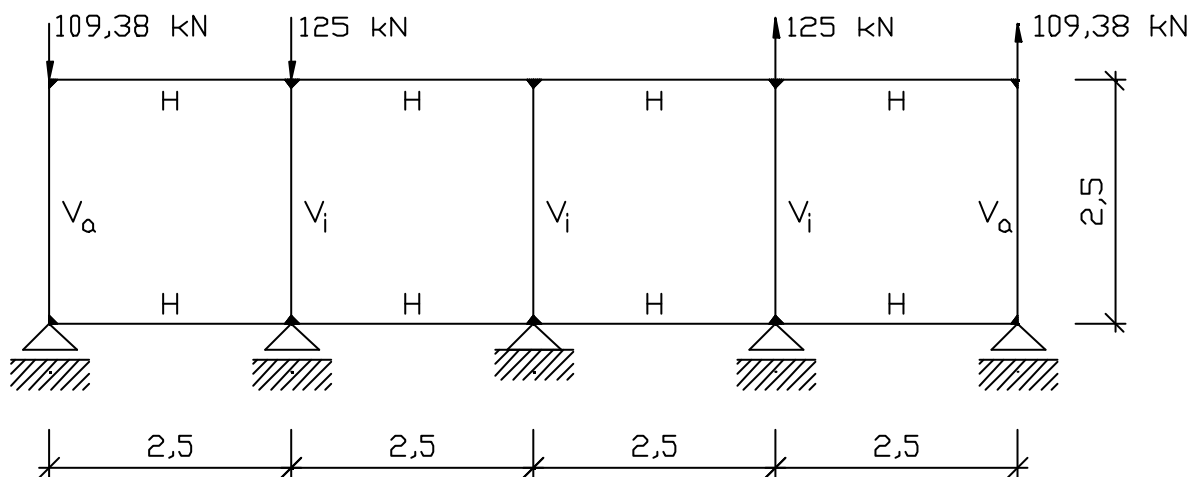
Ersatzmodell für Brettlagenholz mit orthogonaler Struktur
